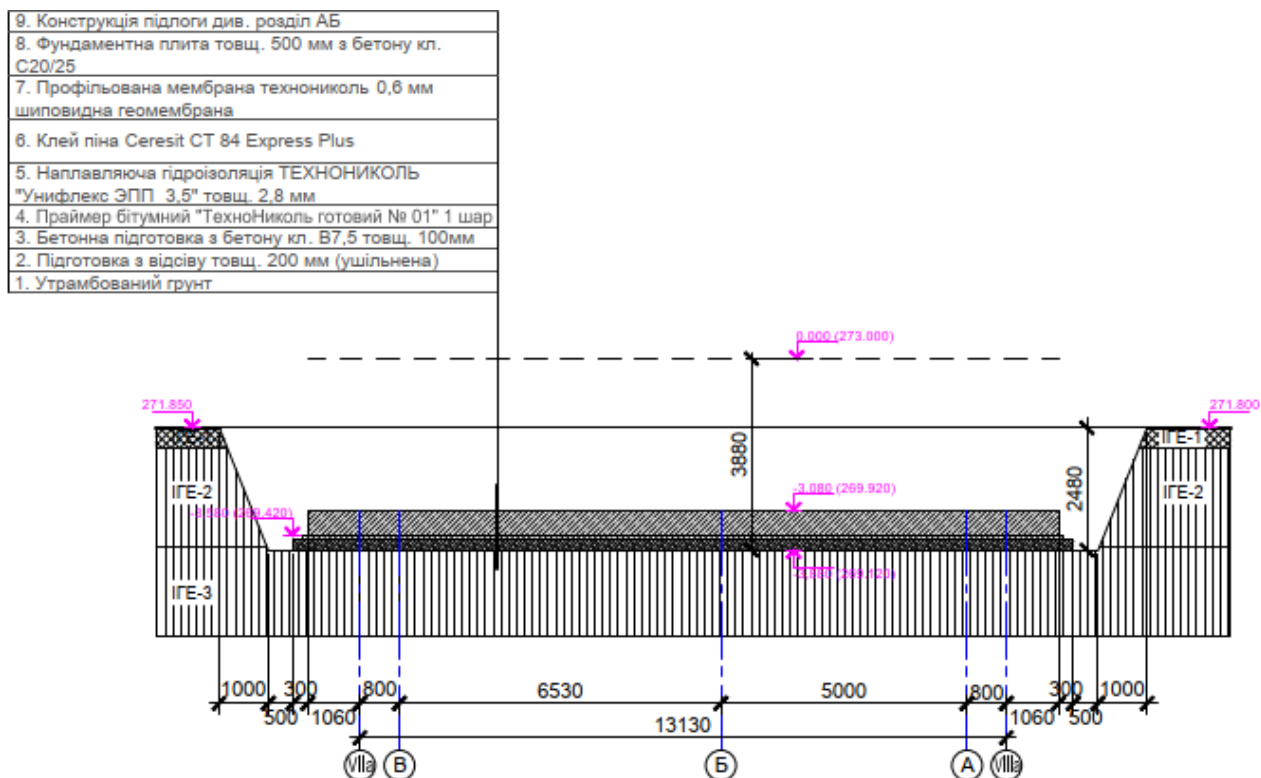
Конструкція фундаментної плити у котловані
